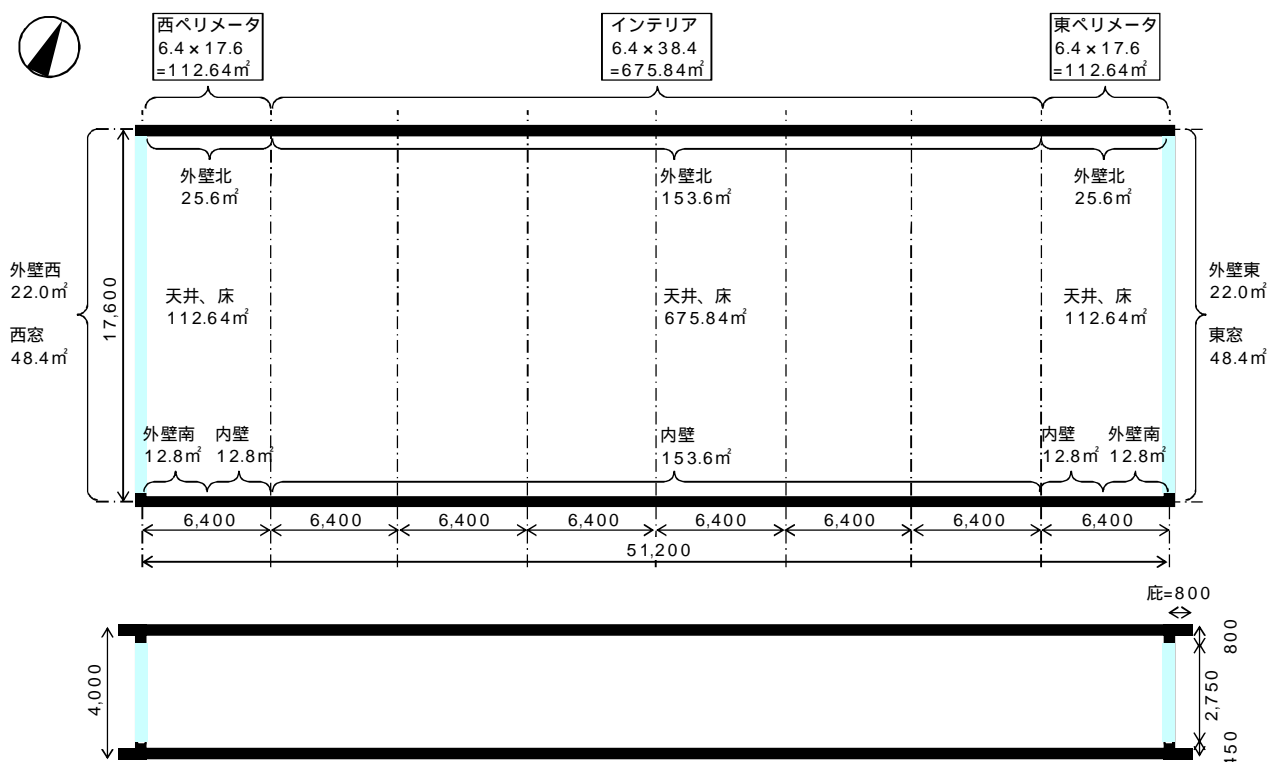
Aビルのモデル化した平面図（上）と断面図（下）
